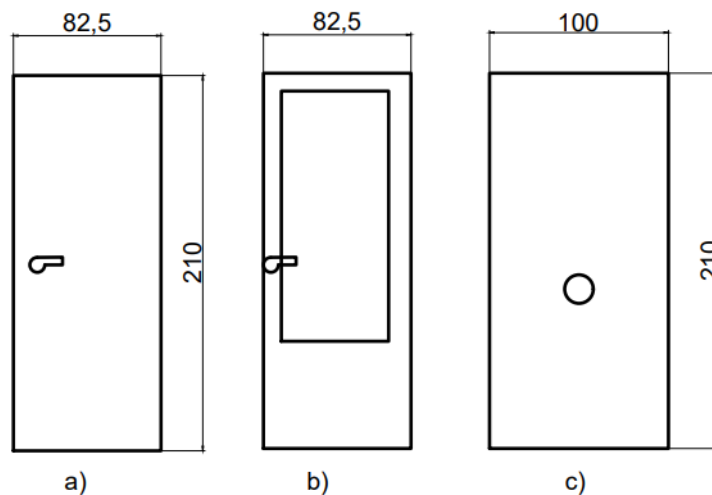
Dimensiones (en mm) de: a) Puertas interiores. b) Puertas del porche. c) Puerta de entrada.
